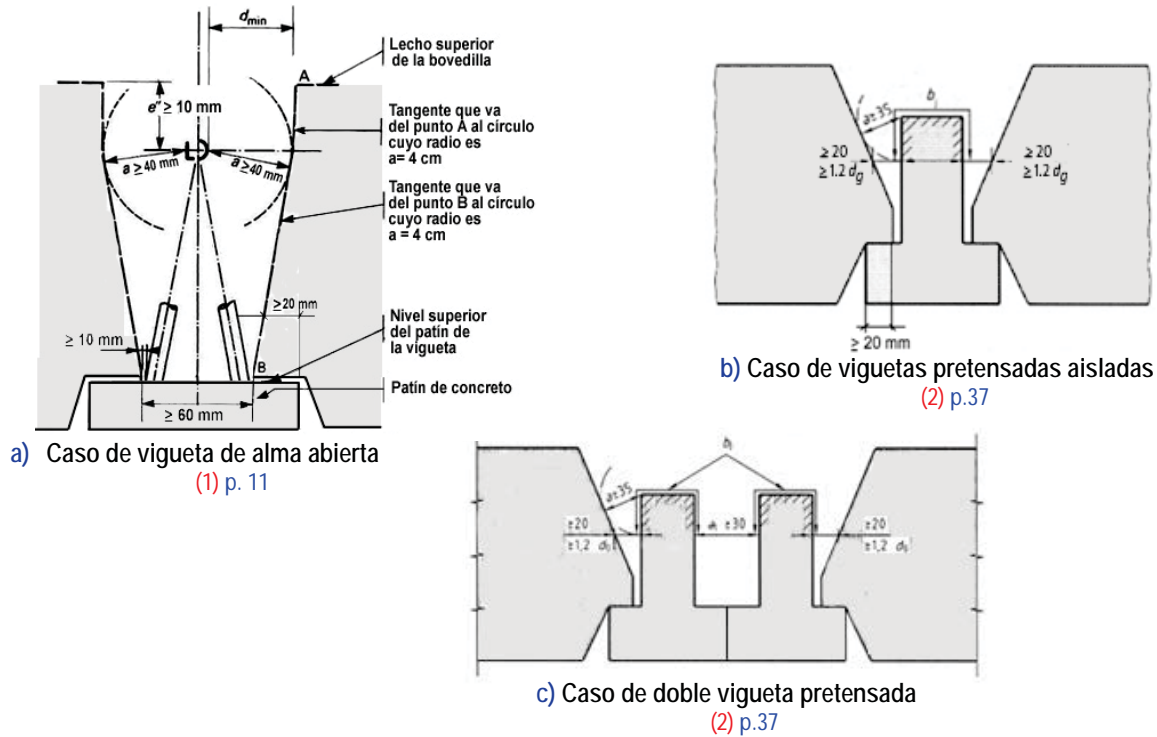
CONDICIONES DE APOYO DE BOVEDILLAS SOBRE VIGUETAS DE ALMA ABIERTA Y DE ALMA LLENA para permitir un trabajo mecánico solidario entre viguetas y la capa de compresión (Cotas en milímetros). Ref. (1) CPT Planchers – CSTB, Titre 1, Première Partie: Section A, 1980 y (2) Norma EN-15037-1 – Productos Prefabricados de Hormigón – Sistemas de Forjado de Vigueta y Bovedilla - Parte 1: Viguetas 2010.
